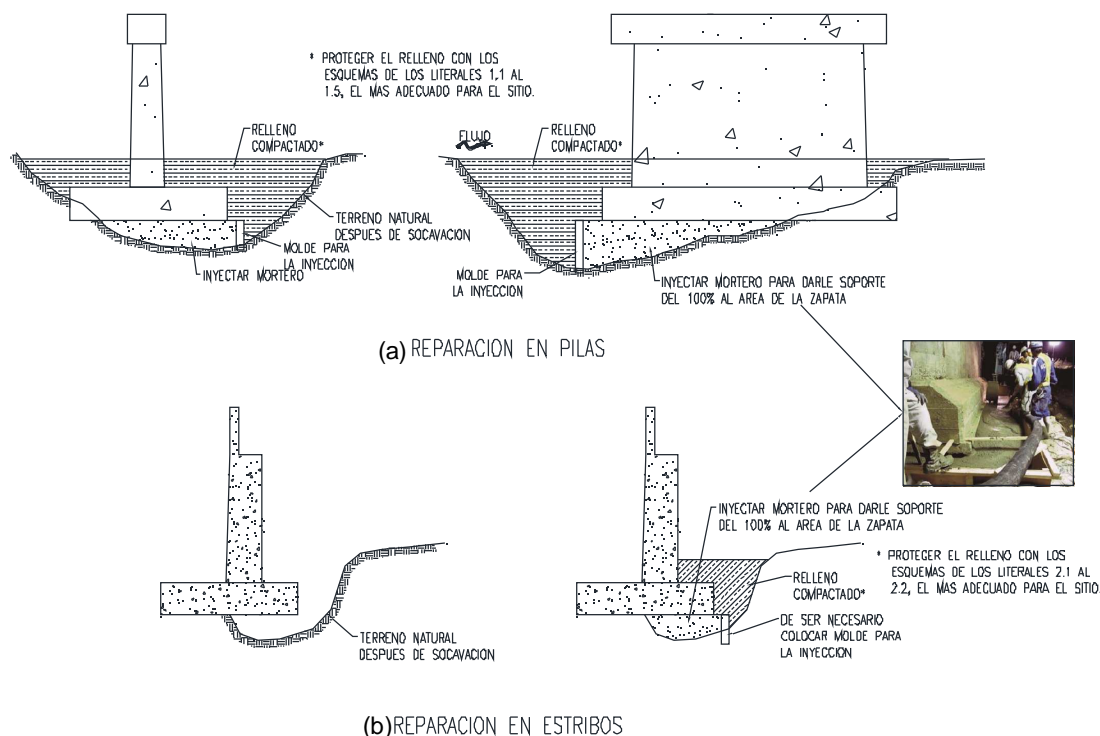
Método propuesto de reparación en fundación directa en (a) estribos y (b) pilas. (SPOP, 2014)
